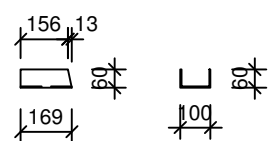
DETAIL ŽLABU U SCHODIŠTĚ Č.2 A 3
